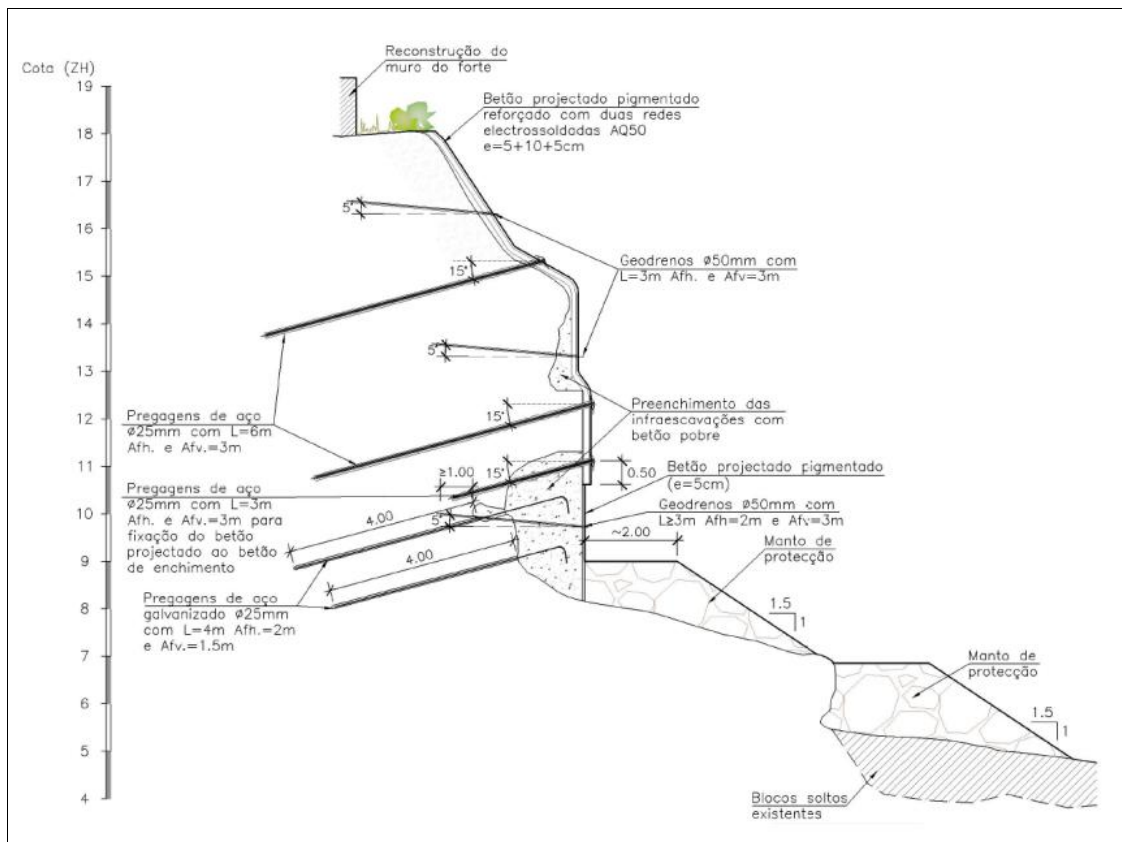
Perfil Tipo- Zona D: preenchimento da infraescavação com betão de enchimento, colocação de betão projetado reforçado com redes eletrossoldadas, pregagens, reconstrução do muro do Forte, colocação de manto de protecção (Silva *et al.*, 2012).
